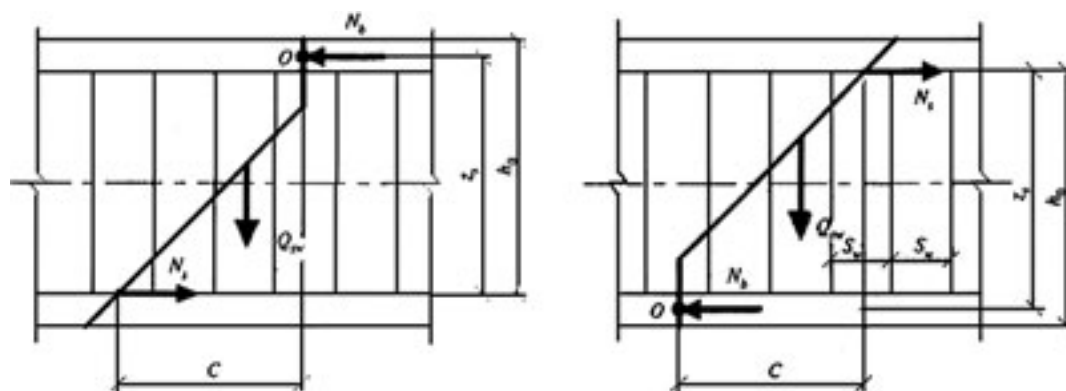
Схема усилий при расчете железобетонных элементов по наклонному сечению на действие моментов
